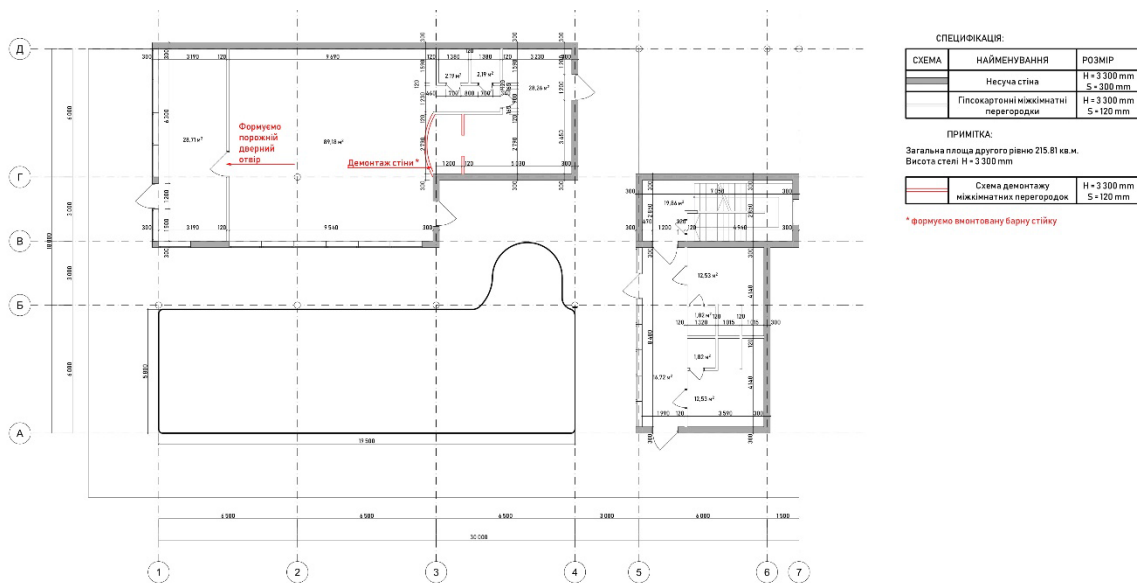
Схема демонтажу міжкімнатних перегородок першого рівню
